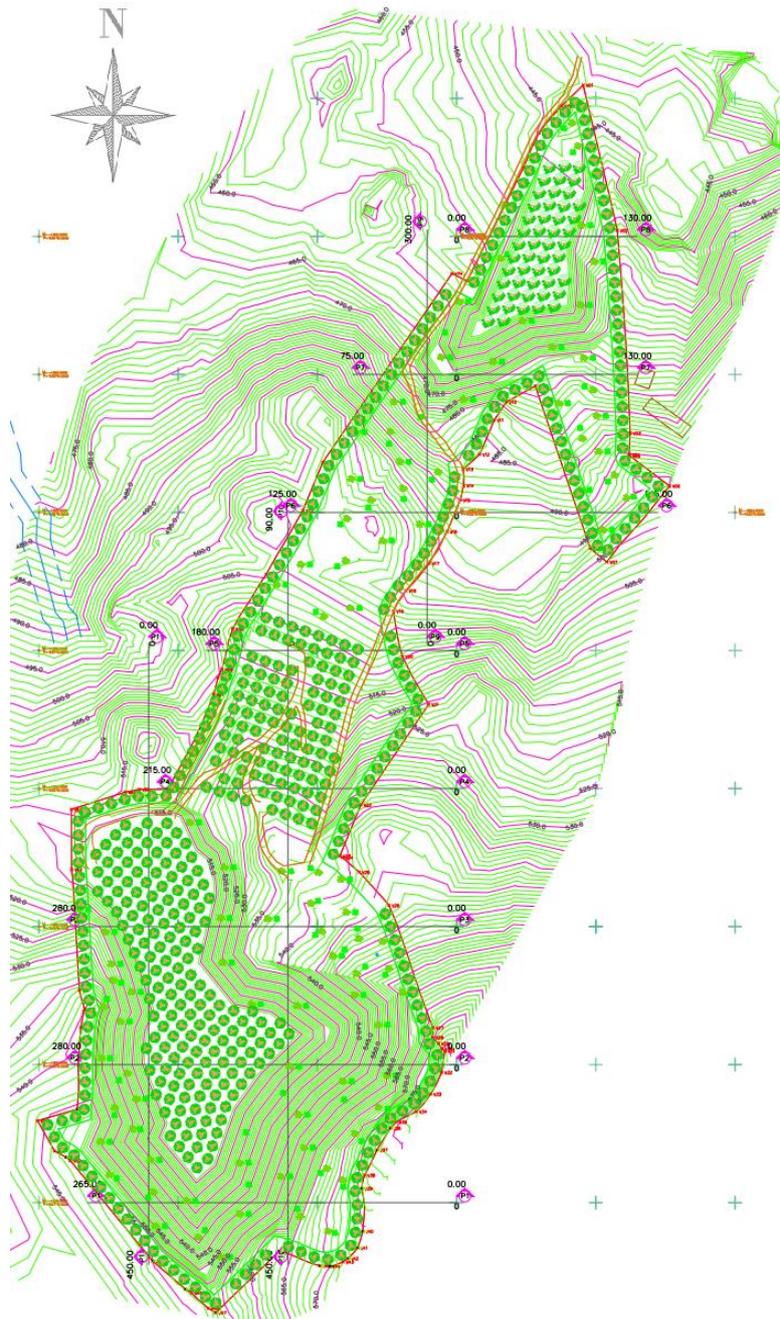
Planta de recuperação paisagística. Fonte: PARP
